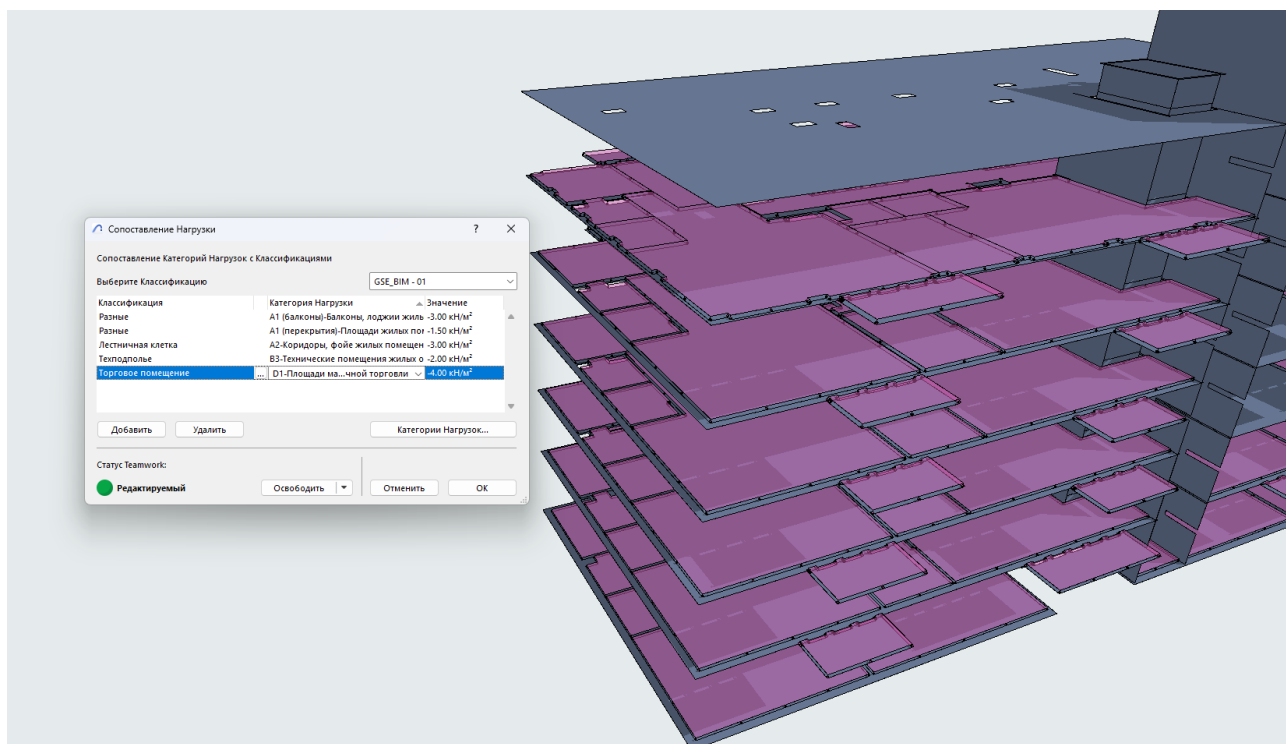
Функциональные нагрузки на перекрытия в ArchiCad 27
